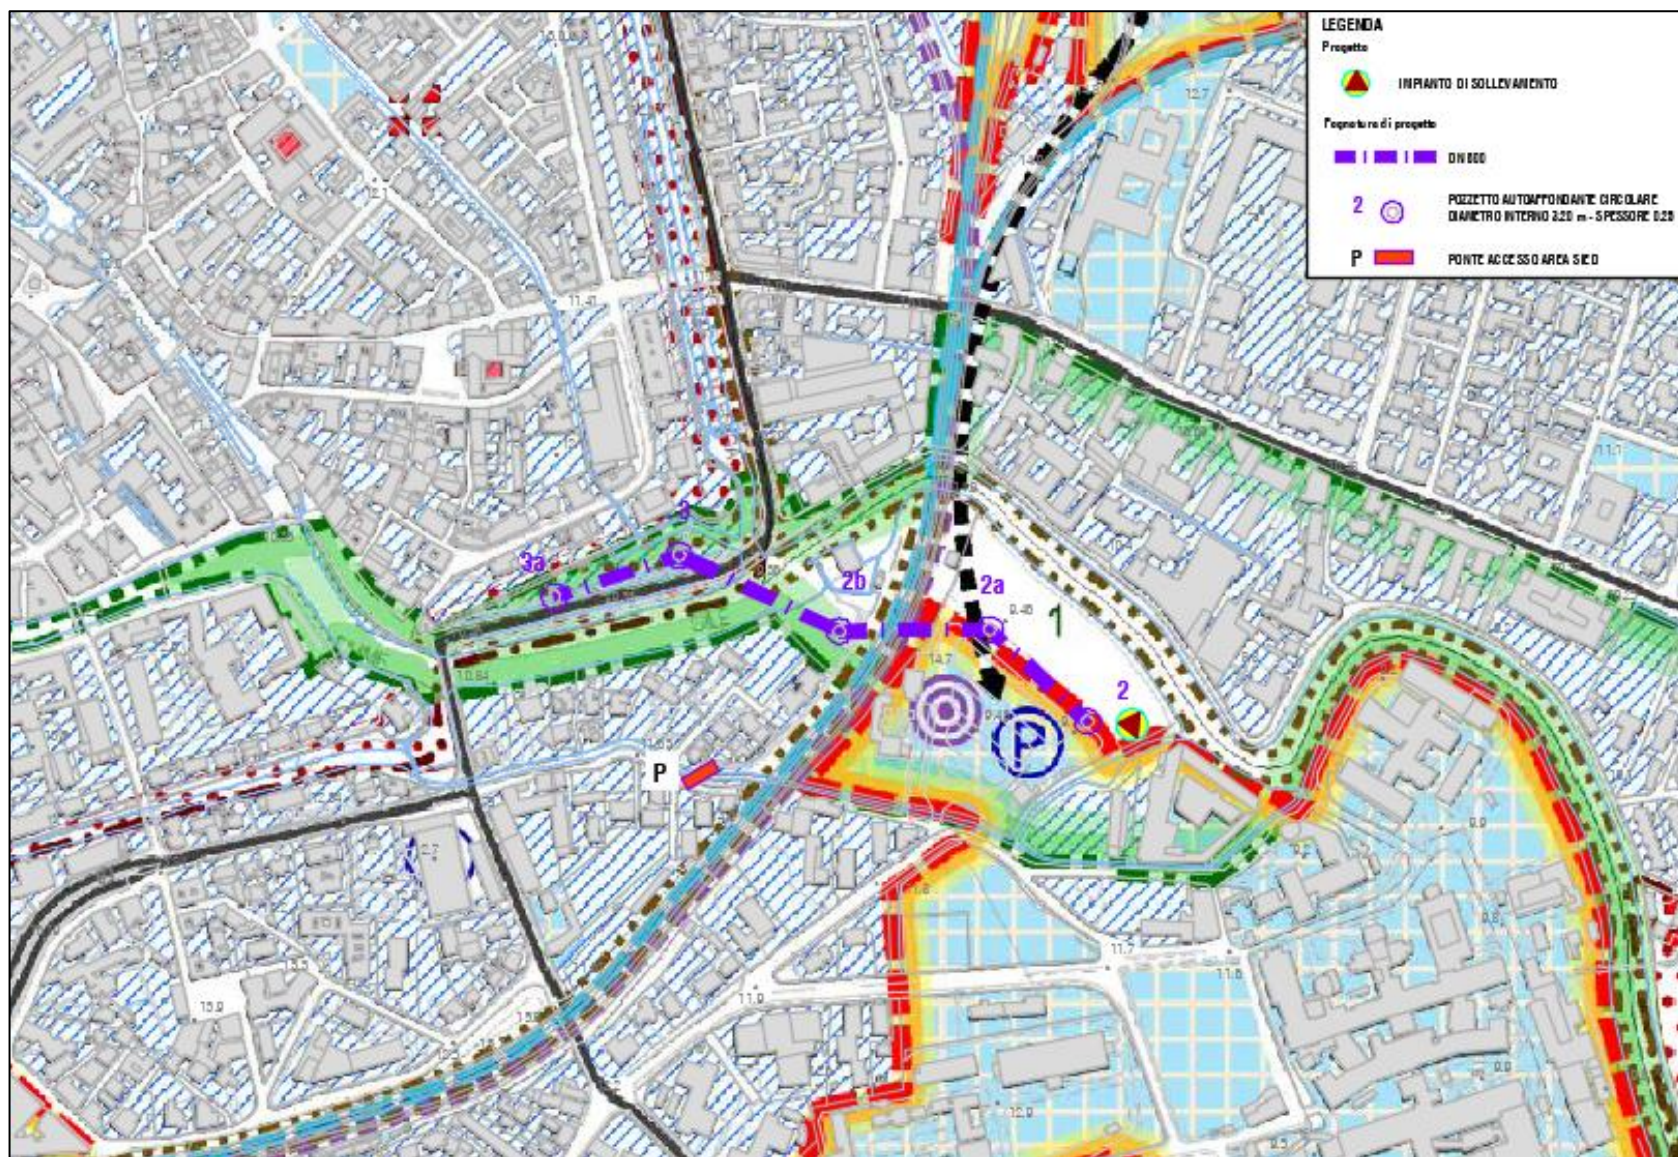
H : Estratto planimetrico – P.A.T. TAV. T04 CARTA DELLA TRASFORMABILITA'
